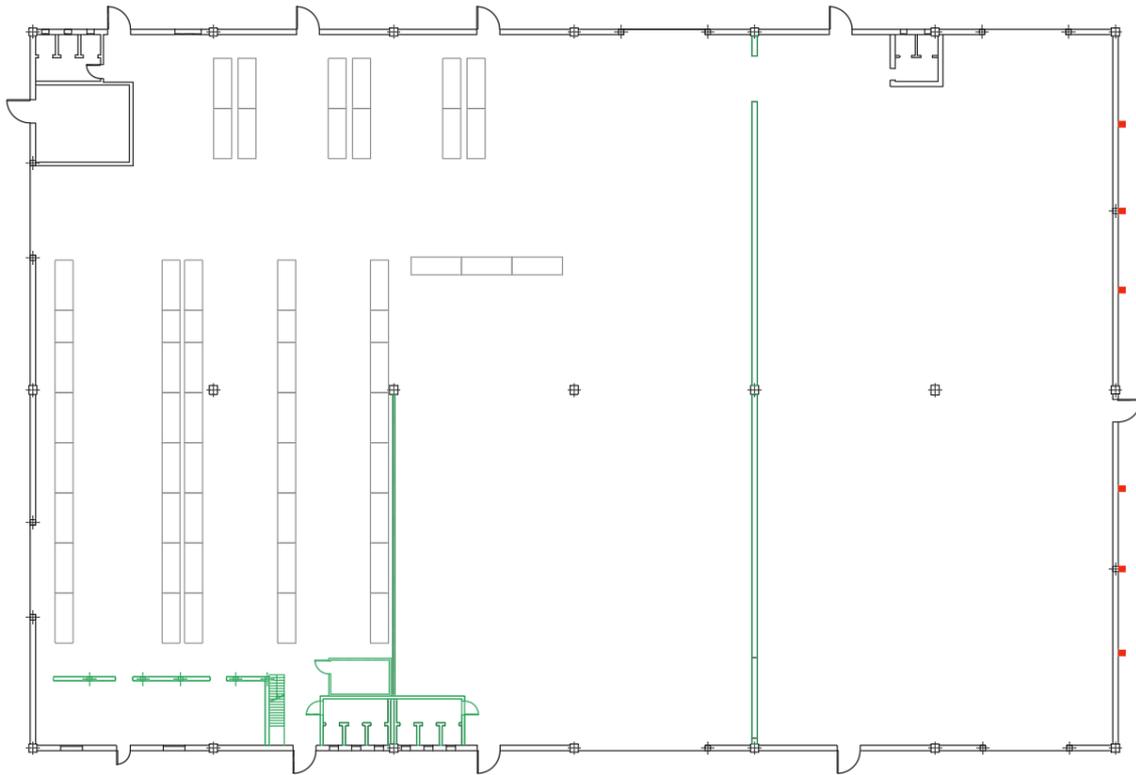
Rappresentazione in pianta dei principali interventi edili volti al miglioramento sismico dell'opificio. In rosso sono raffigurati i nuovi pilastri di rinforzo inseriti nella parete di prospetto est, in verde si riportano i principali volumi interni per cui è prevista la demolizione.
